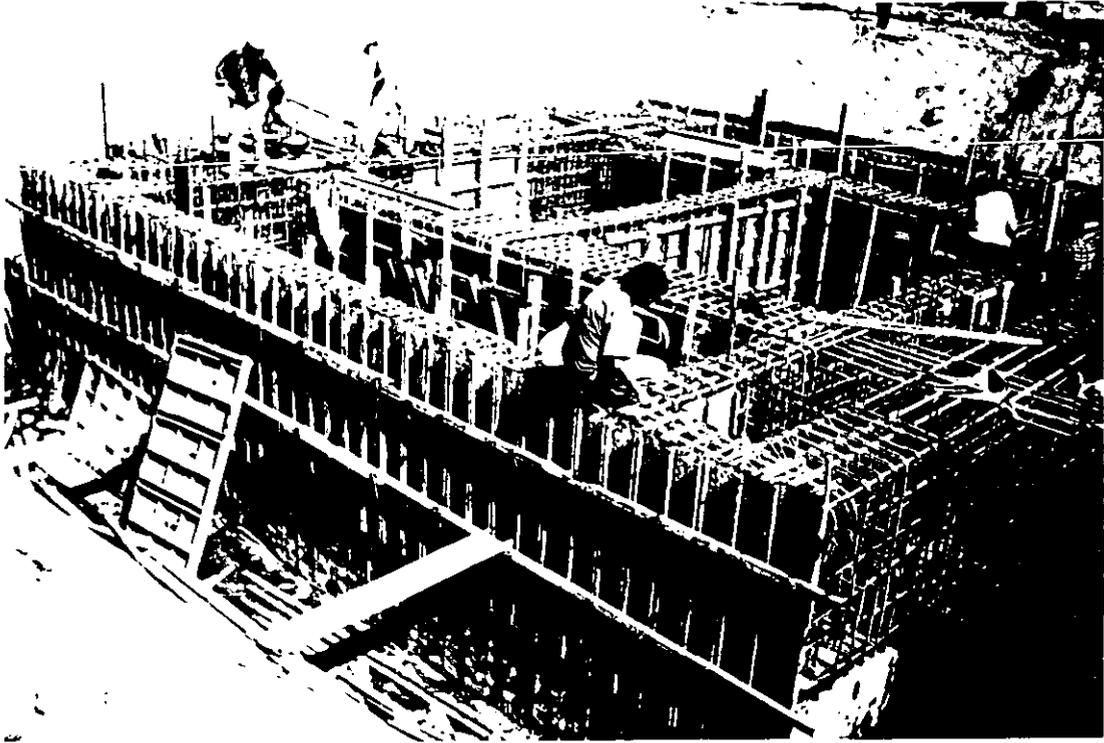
Cimbrado de zapata sobre Avenida Oceanía
